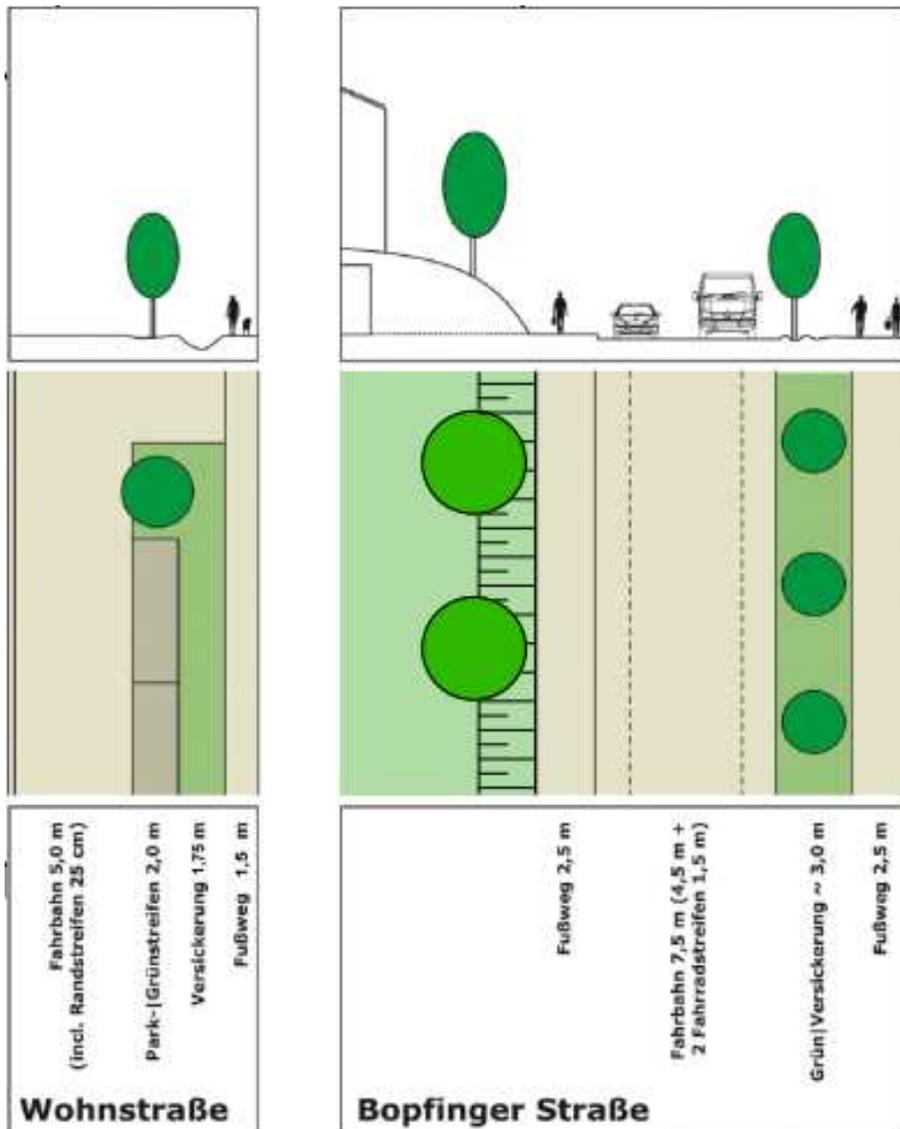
Darstellung der geplanten Straßenquerschnitte (unverbindlich)
